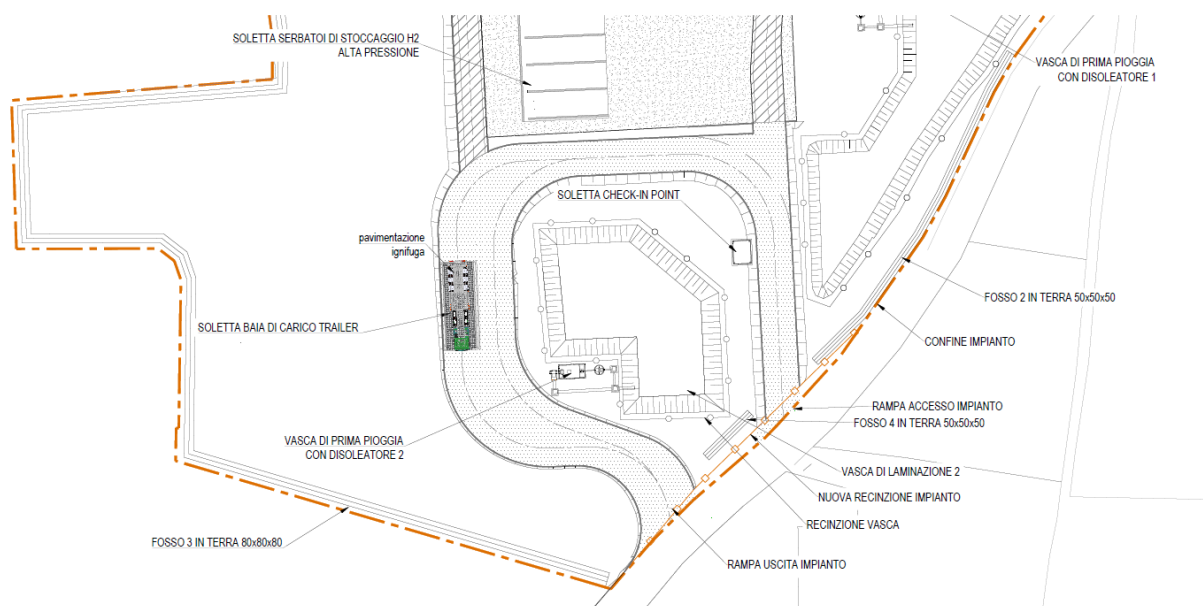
Stato di progetto delle baie in cemento armato per lo stallo dei carri bombolai
